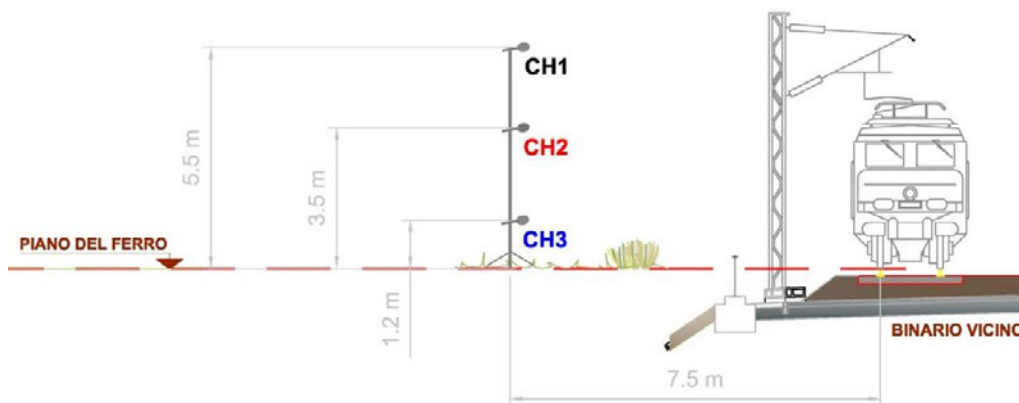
Localizzazione in sezione della postazione di misura ferroviaria
